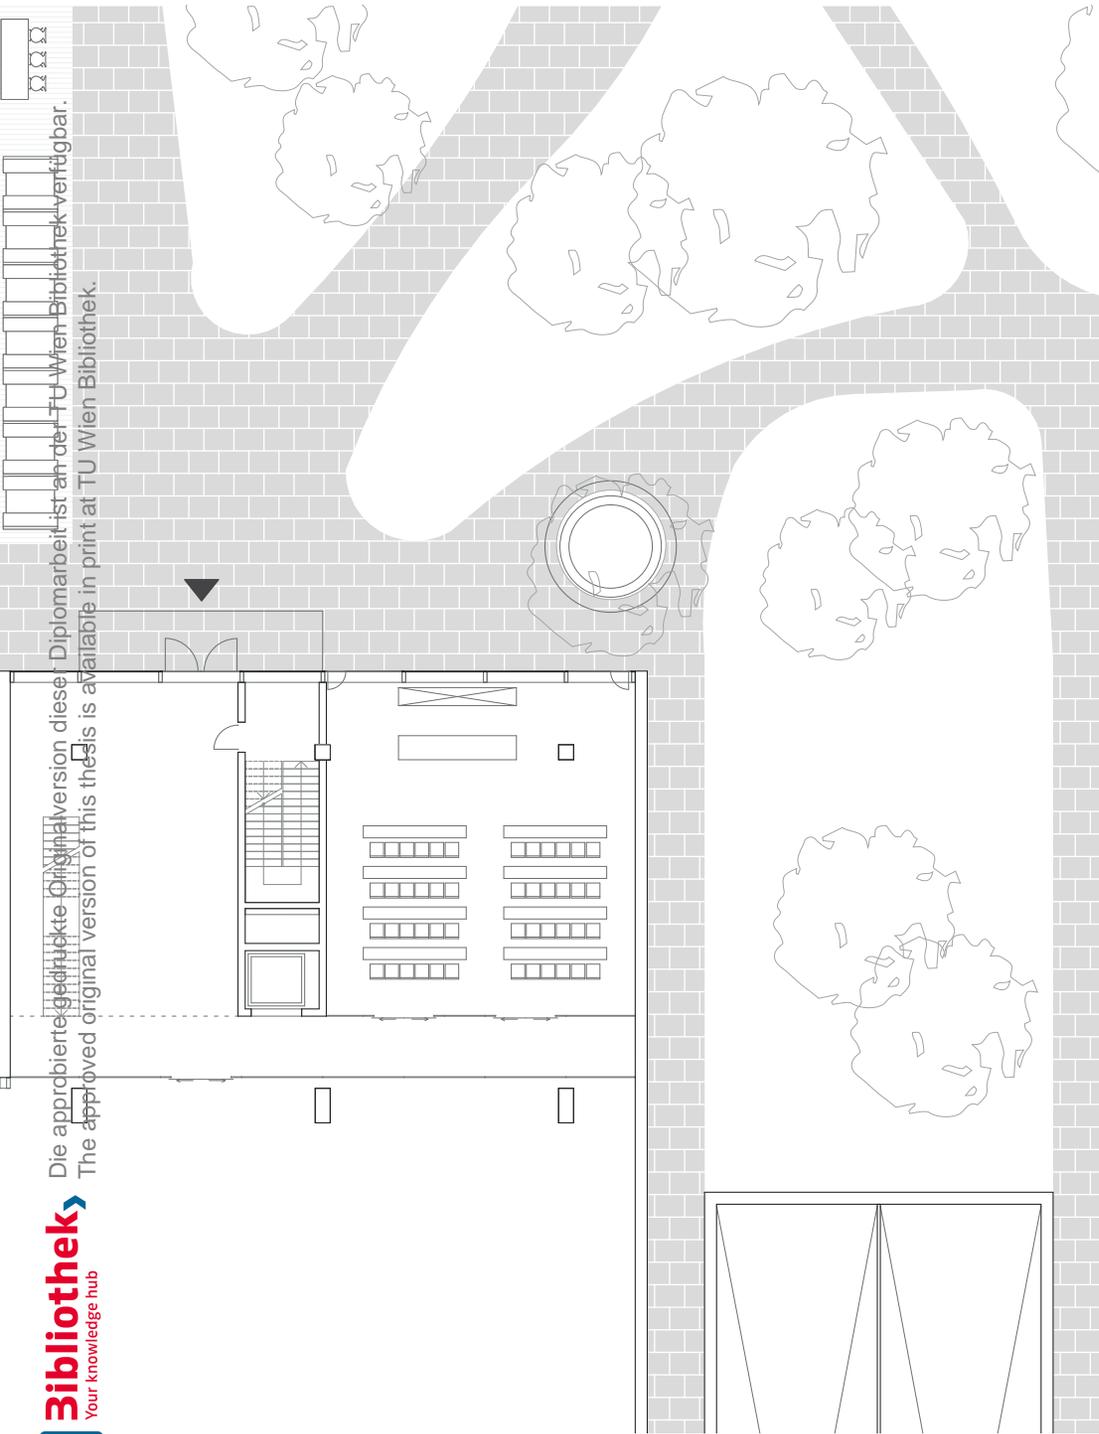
Grundriss 3. Obergeschoss 1:500
